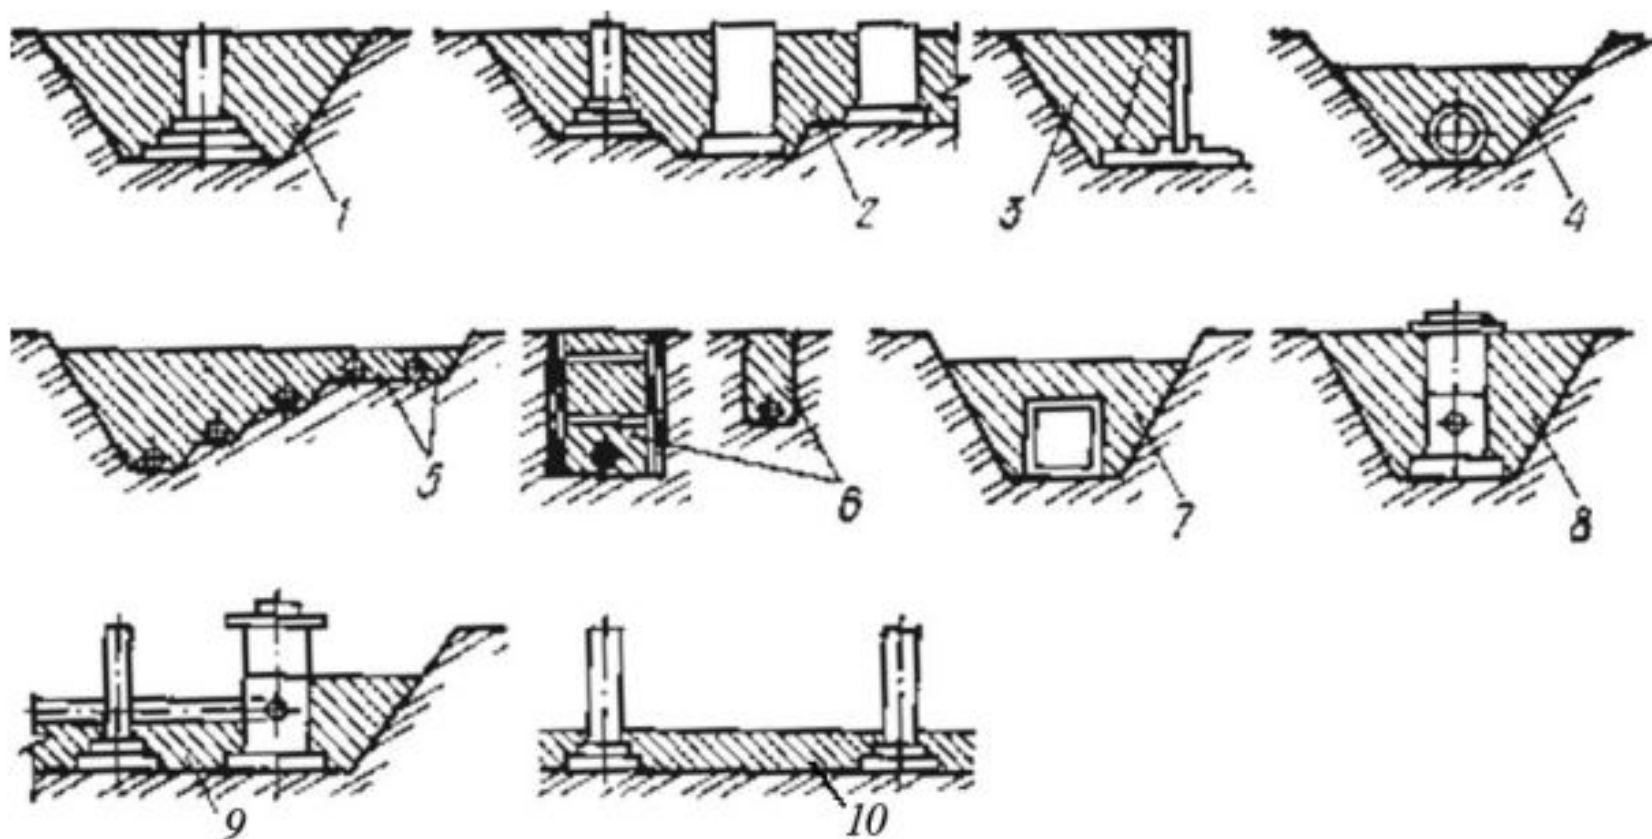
Характерные схемы стесненных мест при обратной засыпке и уплотнения грунтов: 1,2 – пазухи между стенками котлованов и фундаментами под колонны; 3 – то же, между стенками котлованов и подпорными стенками; 4 – то же, между стенками траншей и трубопроводами; 5, 6 – то же, между трубами и стенками траншей; 7,8 – то же, между стенками траншей, коллекторами и смотровыми колодцами; 9 – то же, между трубопроводами; 10 – засыпка грунта под полы внутри зданий
